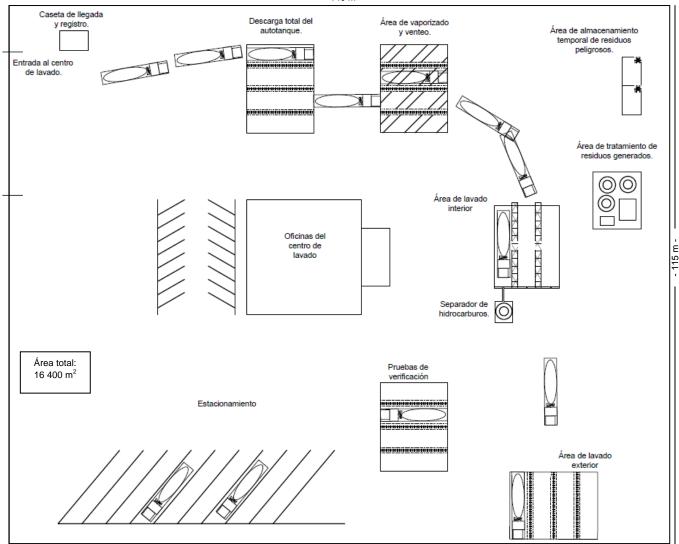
Plano con propuesta de ubicación de áreas en un centro de lavado.
